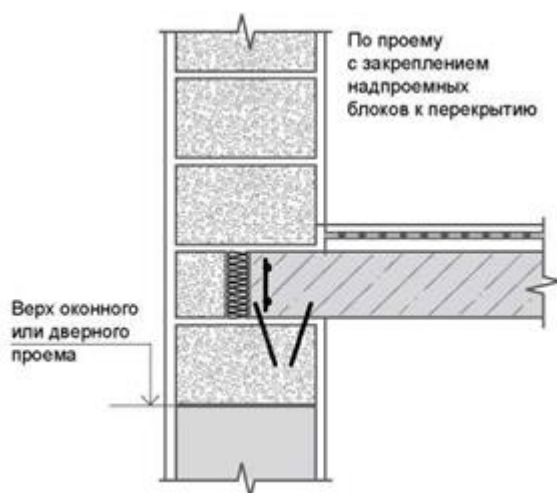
Надпроемные блоки под монолитным перекрытием могут быть закреплены непосредственно к несущему элементу
